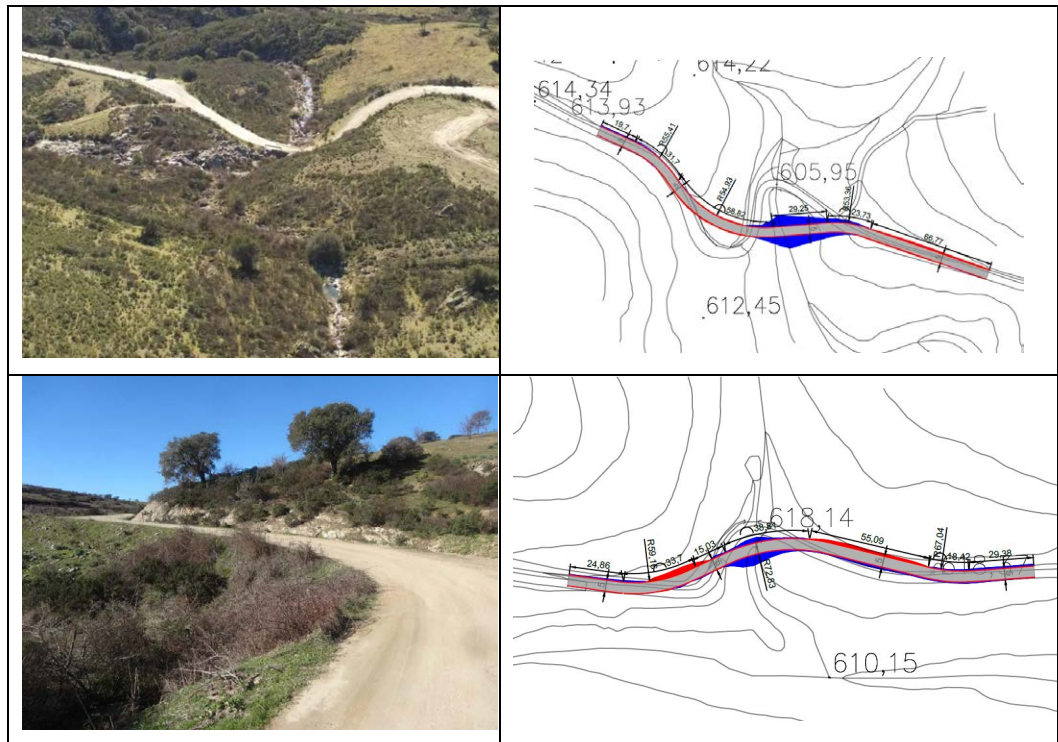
Planimetria attraversamenti temporanei corsi d'acqua
